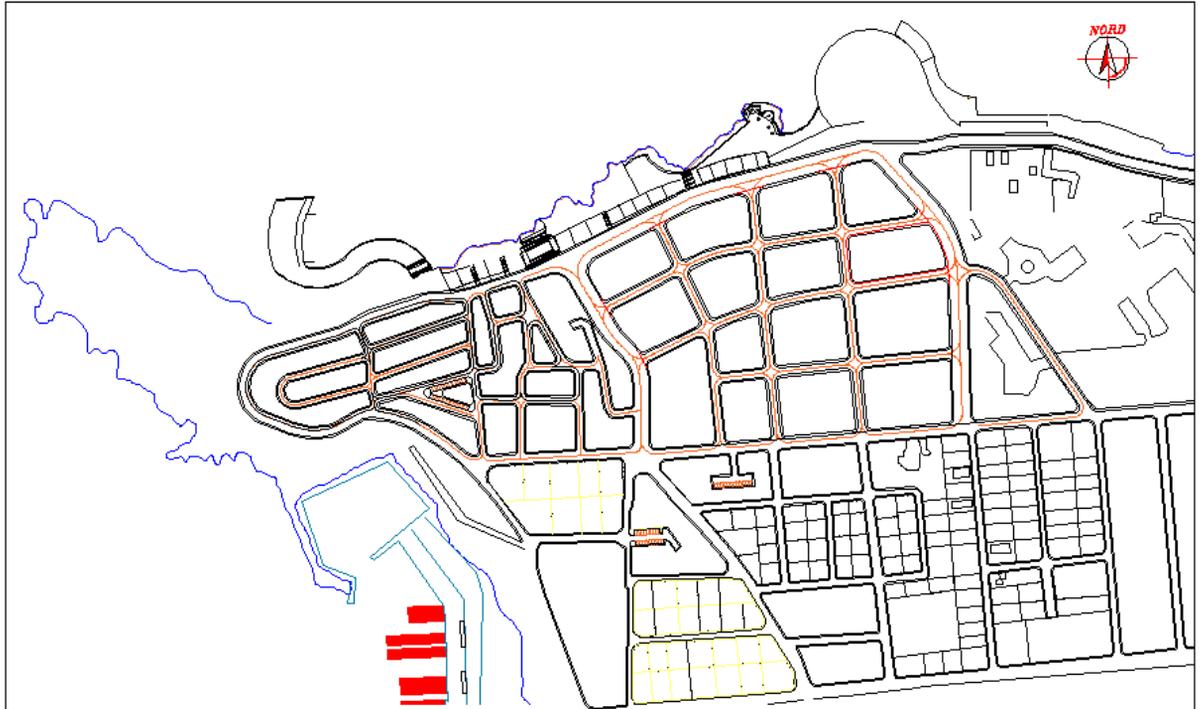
Traçage de la voirie dans le site d'intervention, Source : Travail d'auteur
